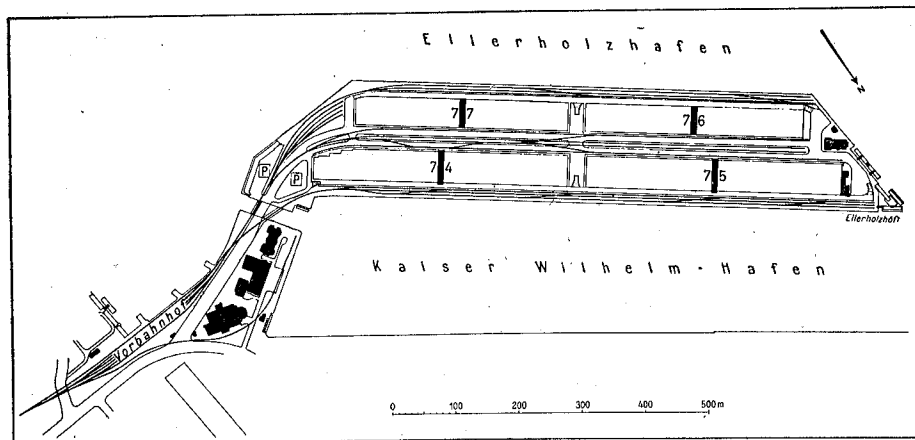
Lageplan einer modernen Hamburger Kaizunge mit Bezirksbahnhöfen in Durchgangs- und Kopfform und Parkplätzen (P) an der Kaiwurzel.
